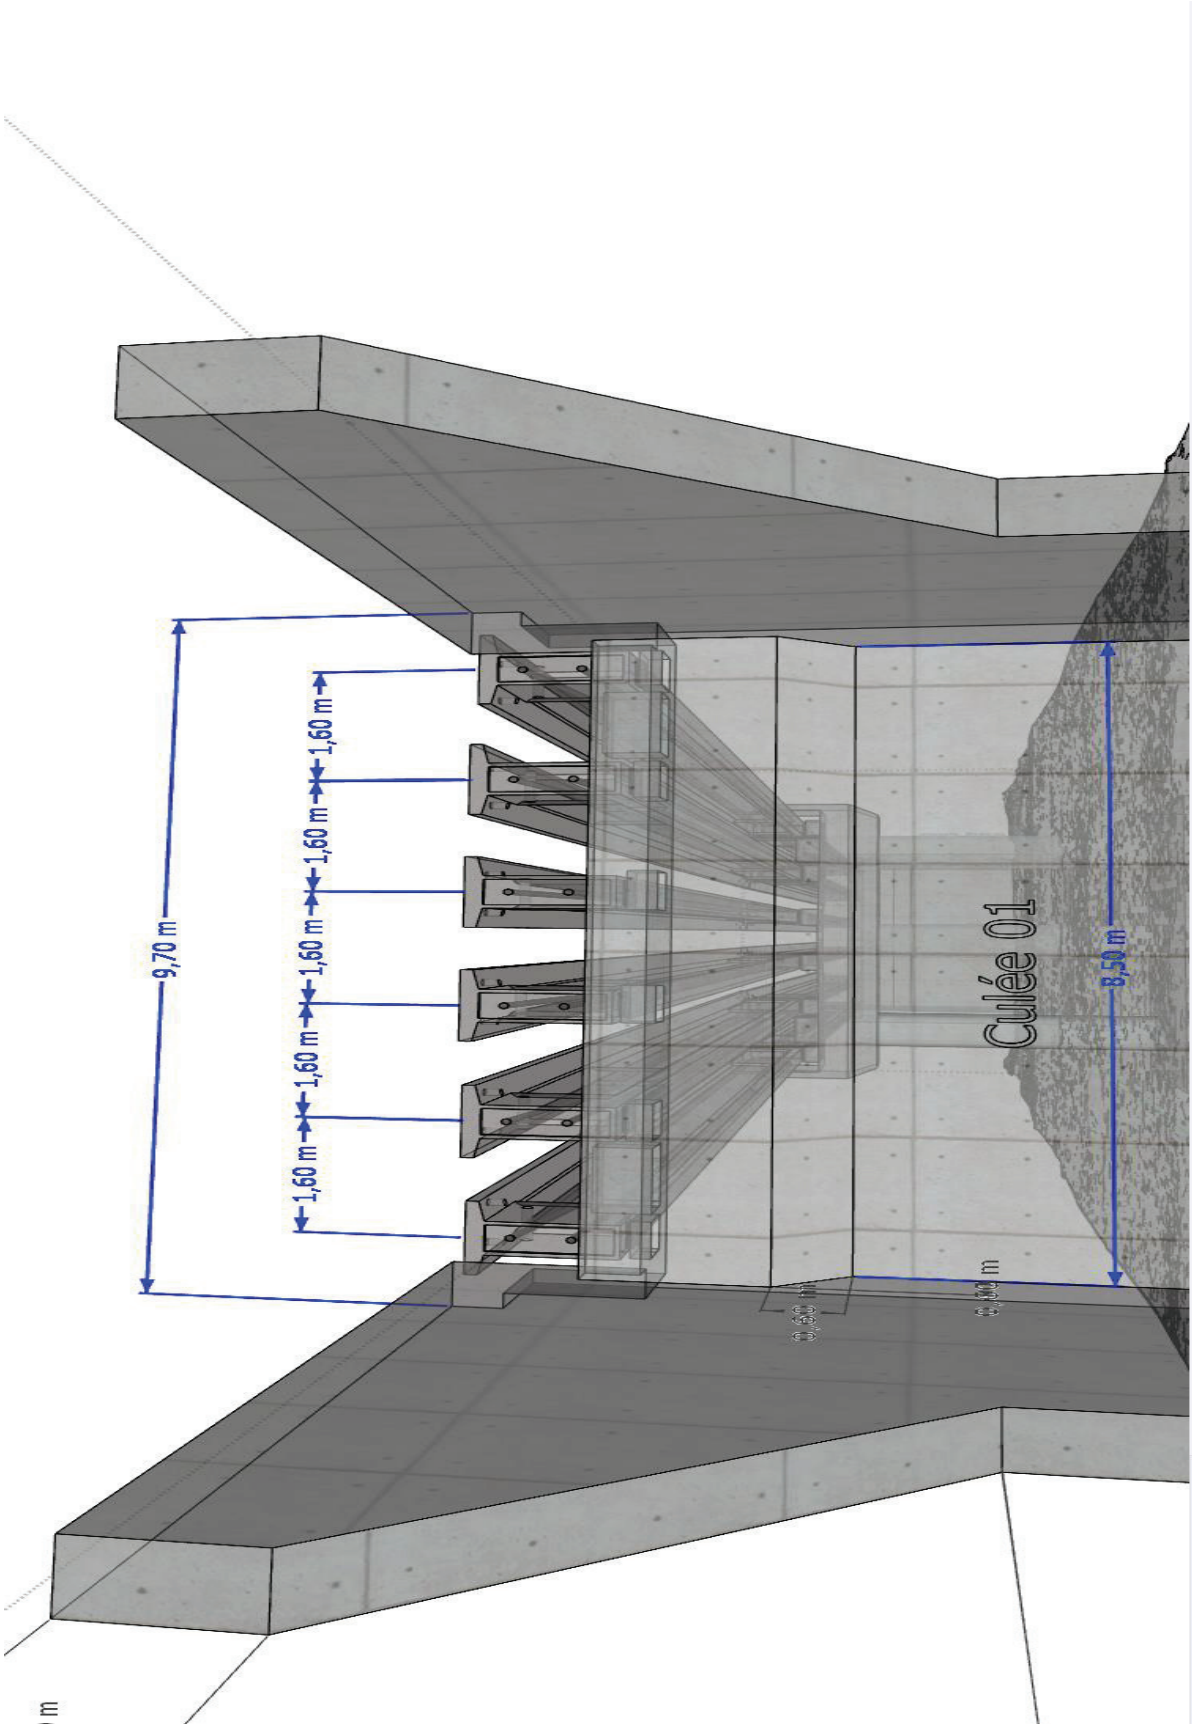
Dimensionnement de la dalle de transition et l'entraxe des poutres de la culée 01
